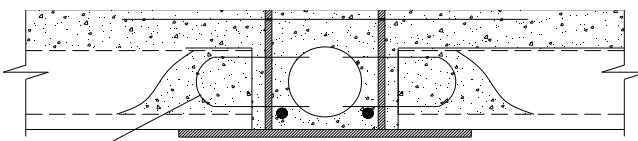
Сборно-монолитное перекрытие с пустотноребристыми преднатяженными плитами.
